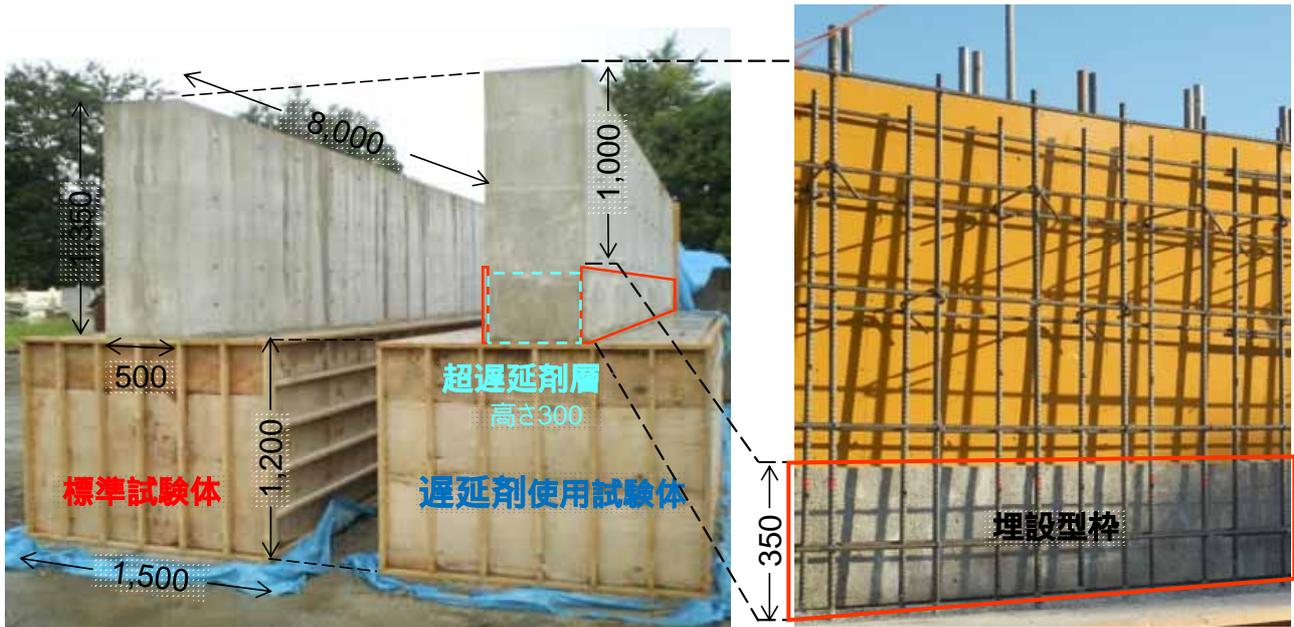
実規模試験体の形状寸法および埋設型枠設置状況
